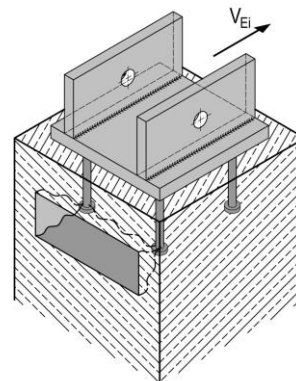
Seitlicher Betonausbruch bei einem Anschluss mit konzentrierter Lasteinleitung
